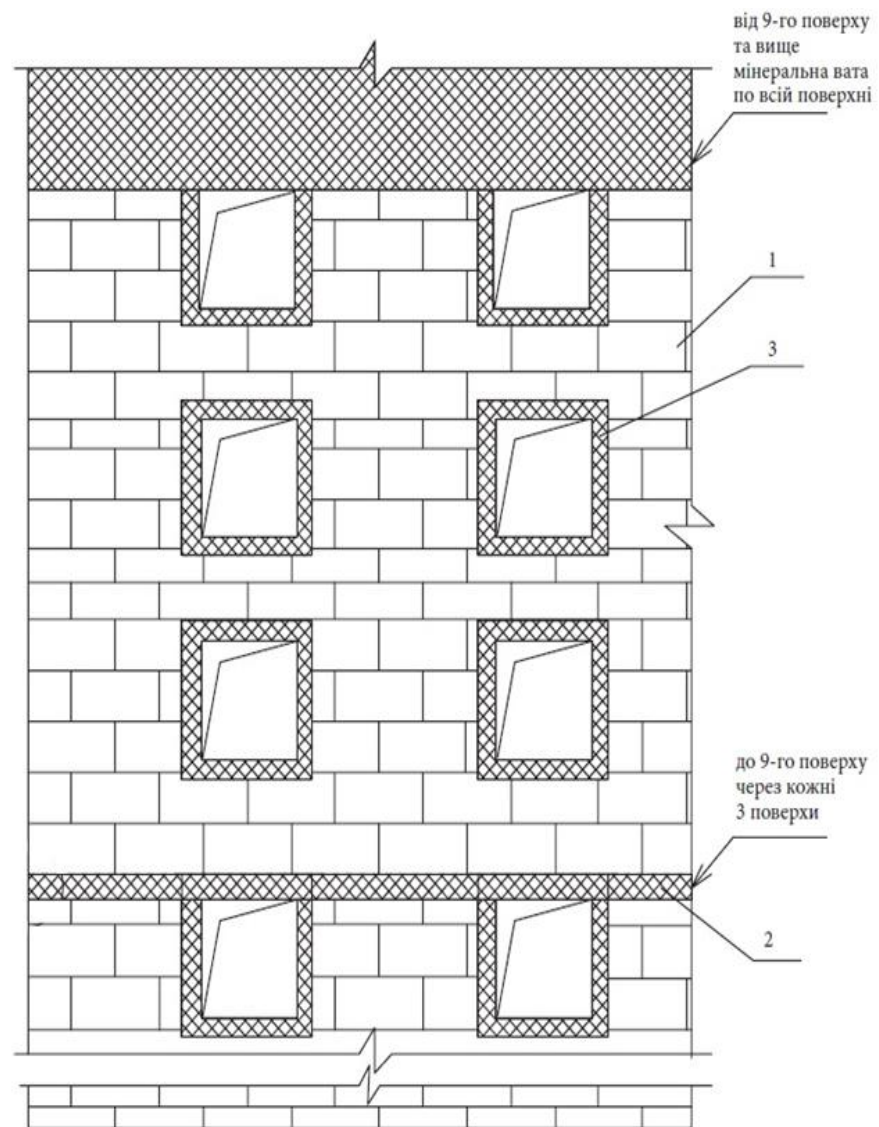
Схема розташування плит утеплювача, поясів розсішок у будинку
